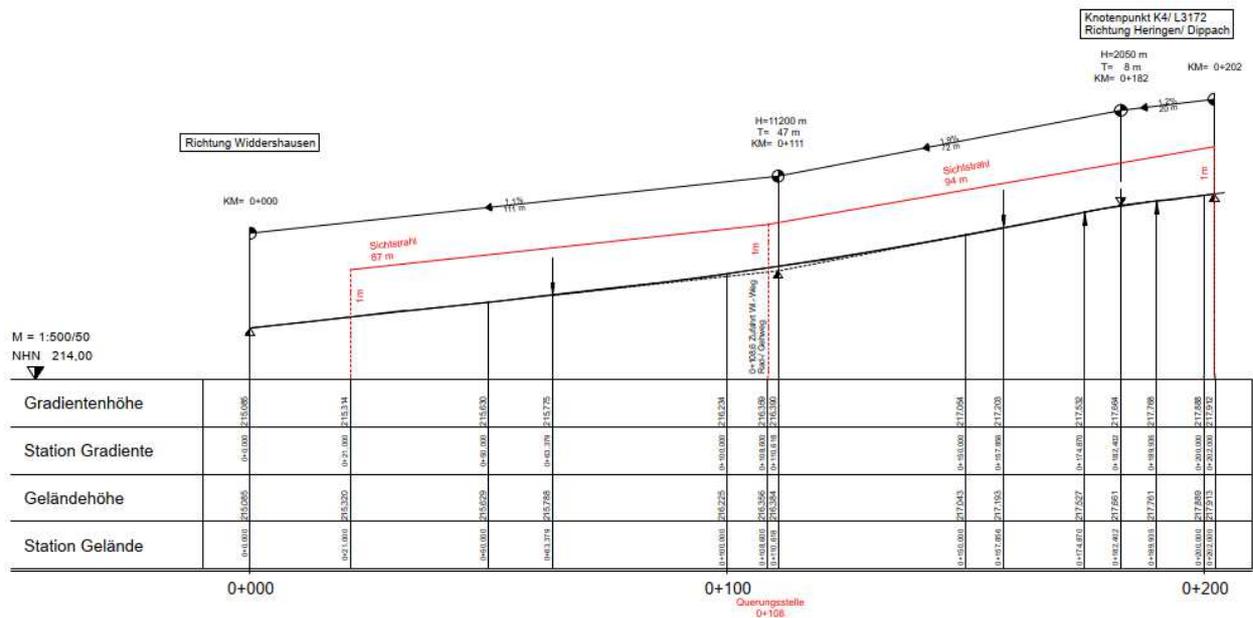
Höhenplan - Ausschnitt Achse 300 (Bestand K 4) mit Sichtstrahl
